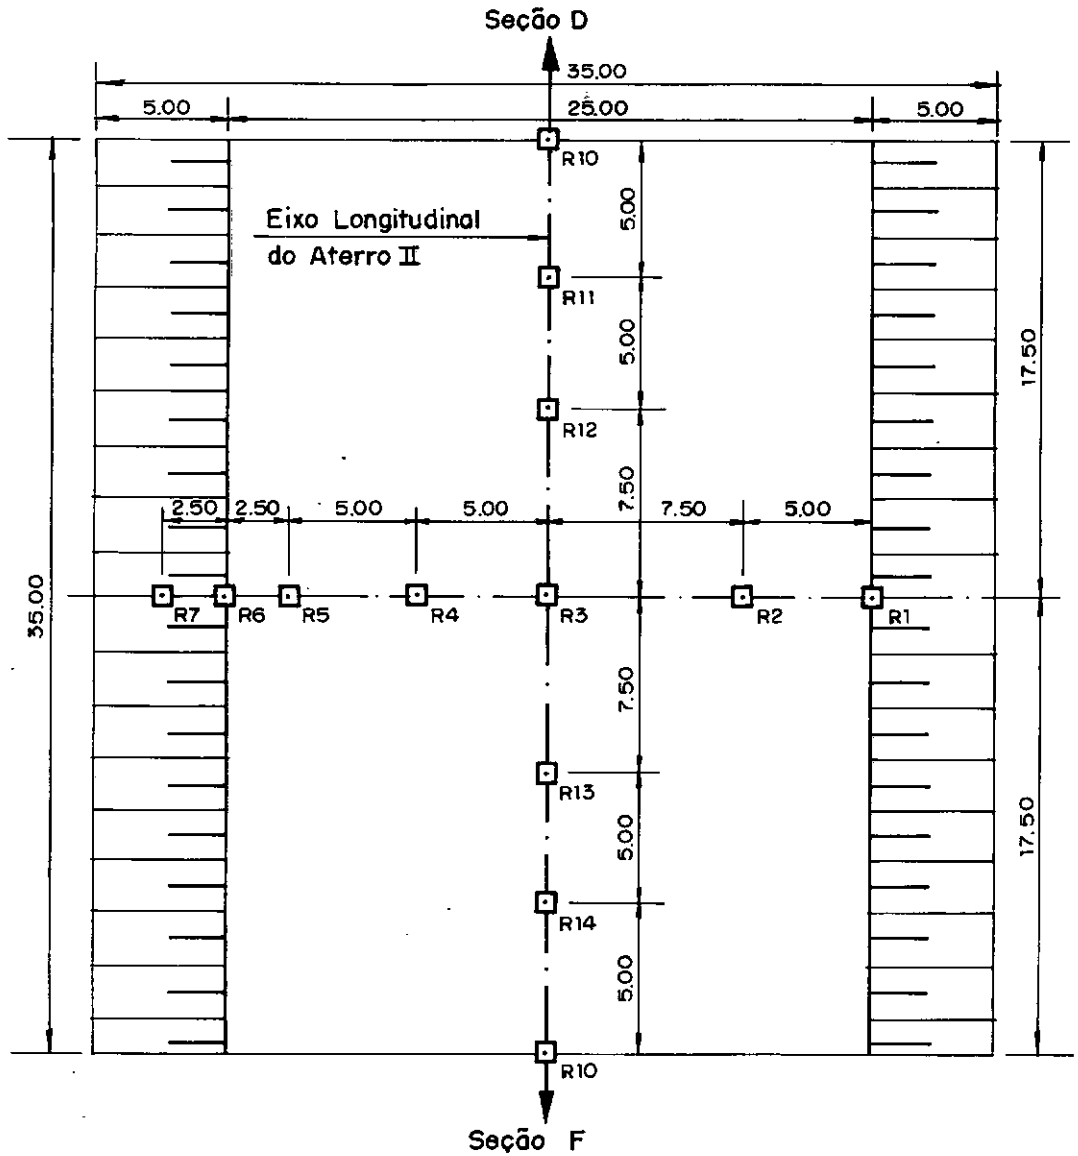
Localização das placas de recalque em planta - Seção E.
